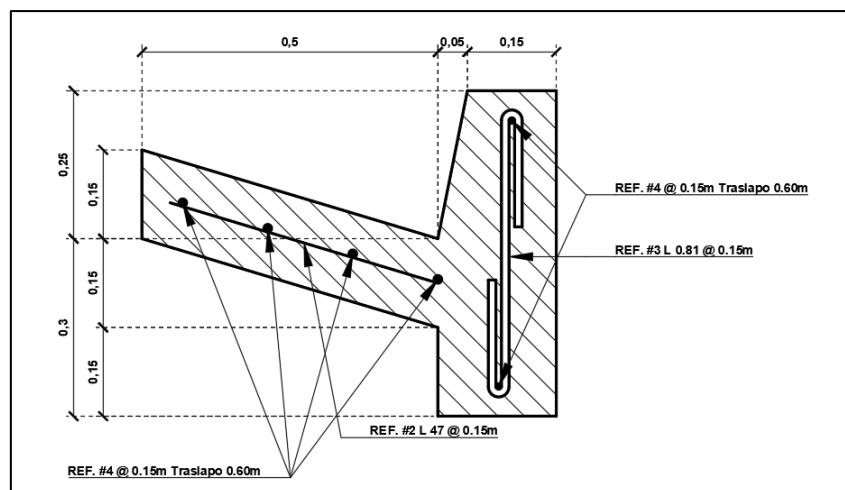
Detalle de refuerzo Berma cuneta y bordillo (propia).
